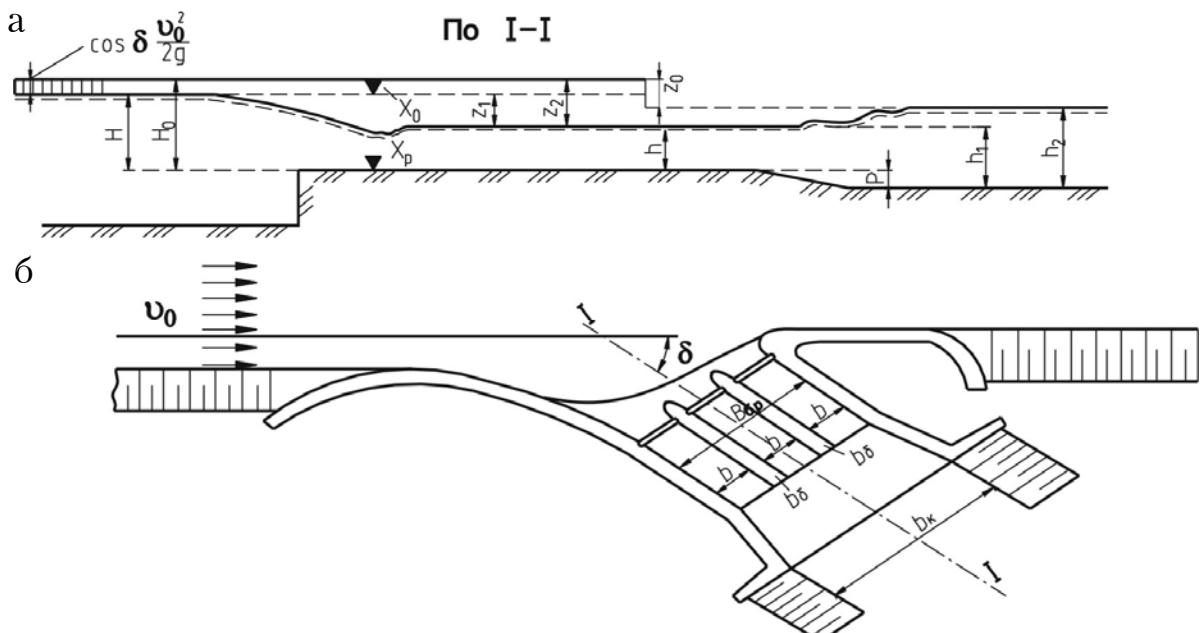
Схема к гидравлическому расчету бесплотинного водозабора:
